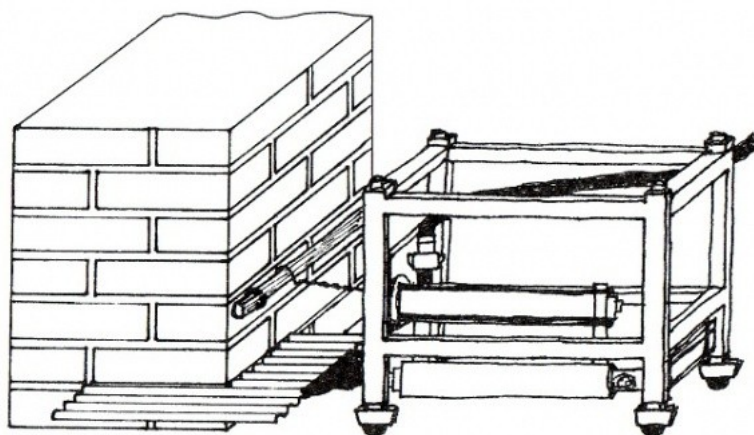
Prořezávání zdiva lanovou pilou [13, 21]
